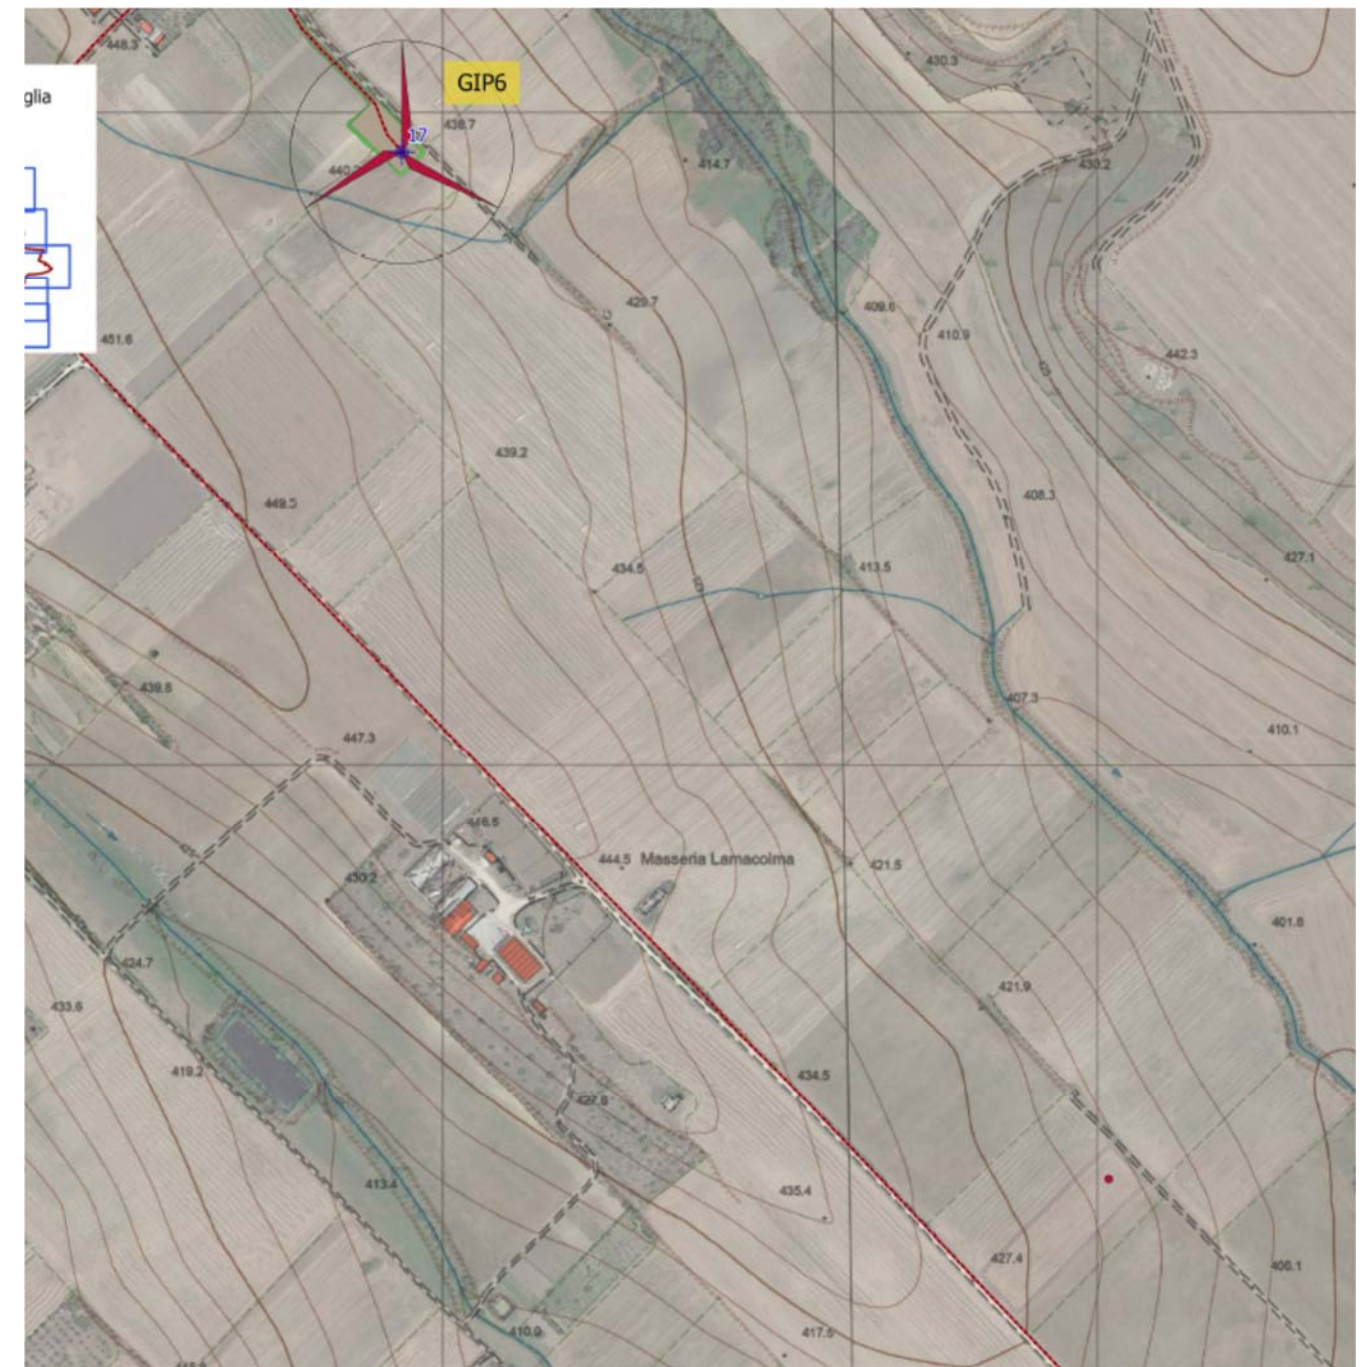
Stralcio planimetria con tracciato elettrodotto (F0433AT13C) – Layout in variante ottobre 2022
